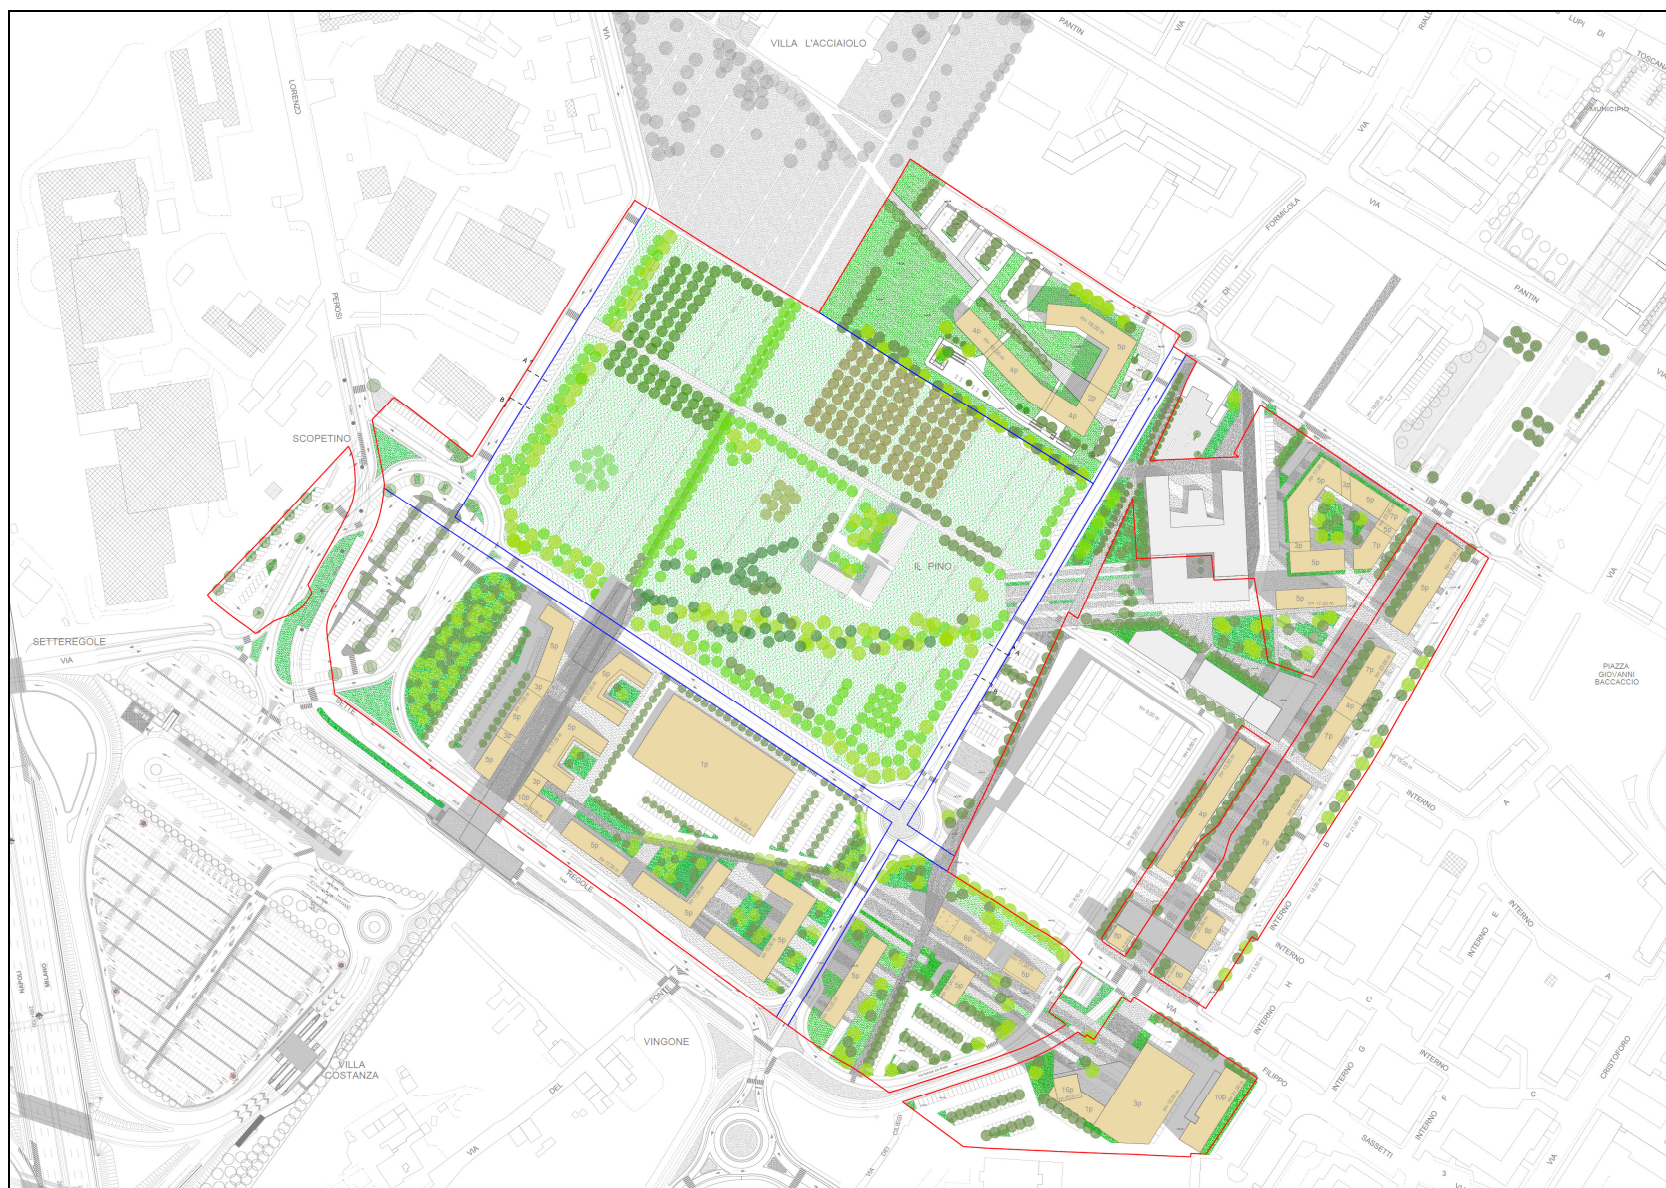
Planimetria Generale del Piano Particolareggiato su CTR.
